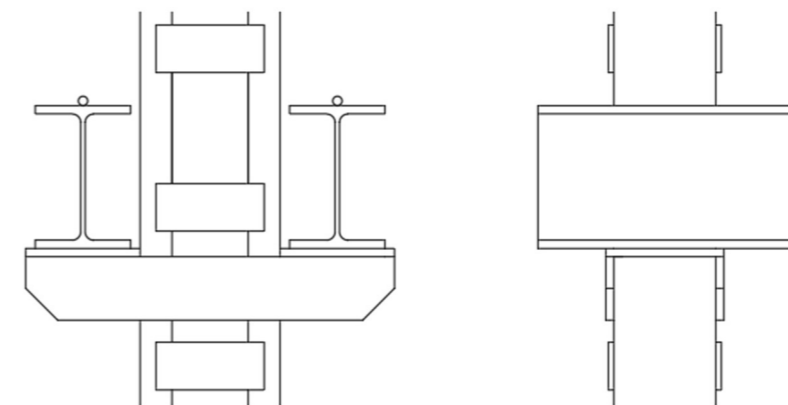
Detalle unión viga carrilera con pilar central de los pórticos principales.
